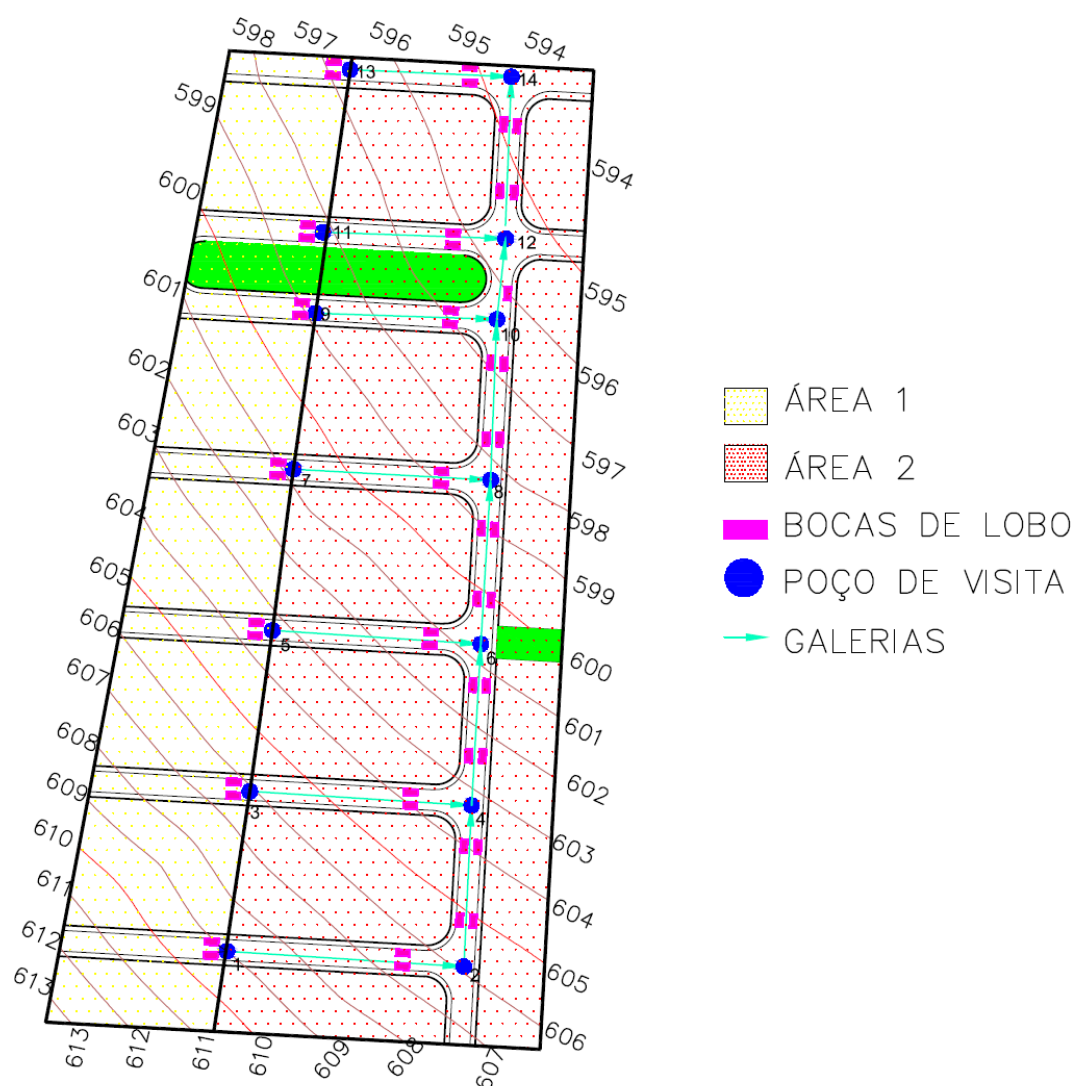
Área de estudo e disposição dos elementos – sem escala.
